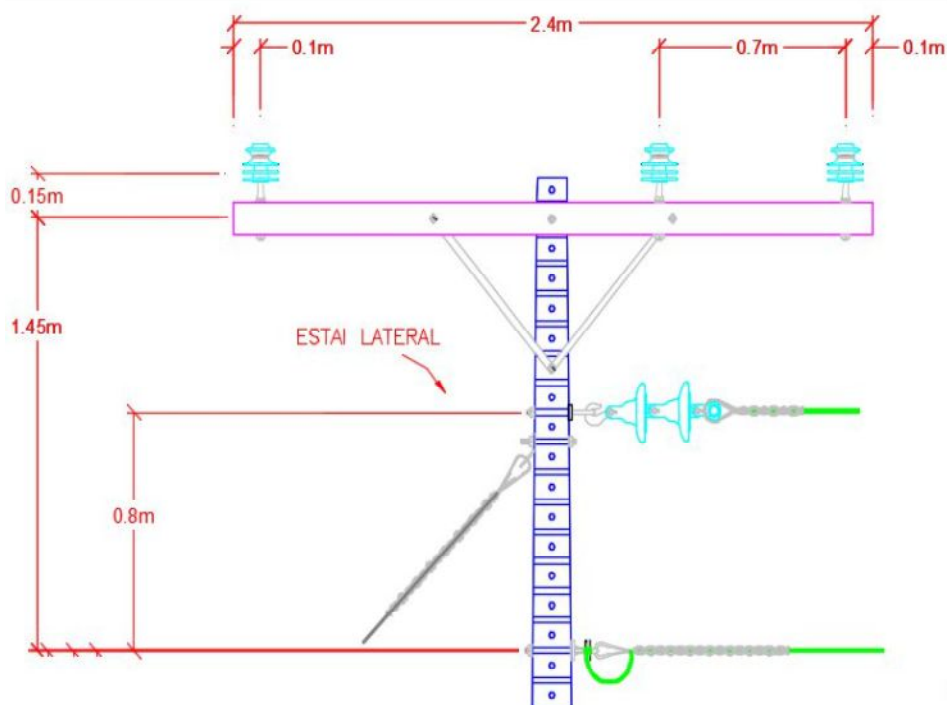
Metodologia de Levantamento de Dados das Estruturas Tipo P - Pilar. Fonte: Própria Autoria.
